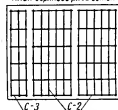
136. Расположение сварных сеток при армировании фундамента узкими сетками.
